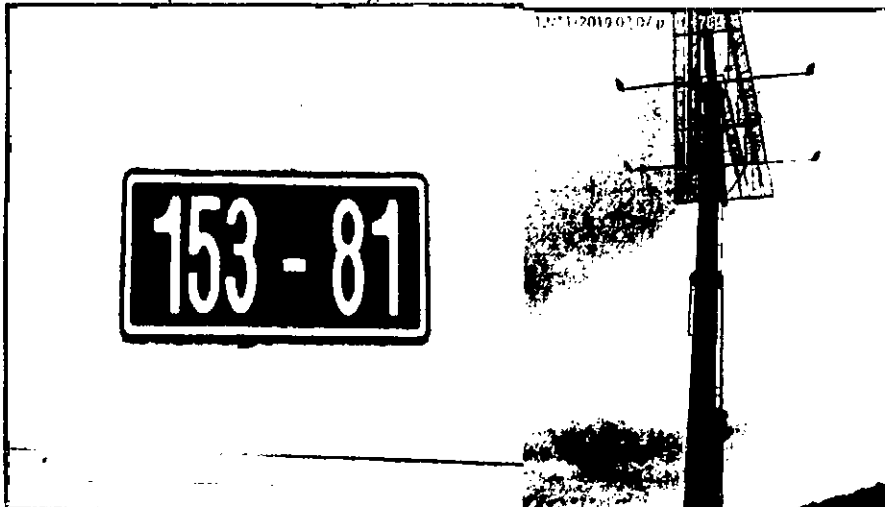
Y 4: Nomenclatura del predio y detalles de la estructura y mastil de la valla tubular, en buenas condiciones y estable, instalada en la Av. Carrera 45 No. 153-81 (dirección catastral), orientación Norte-Sur.
